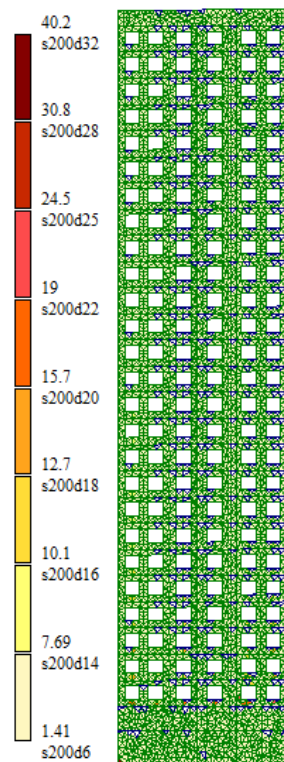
Схема армирования стен по оси X (у нижней грани)
